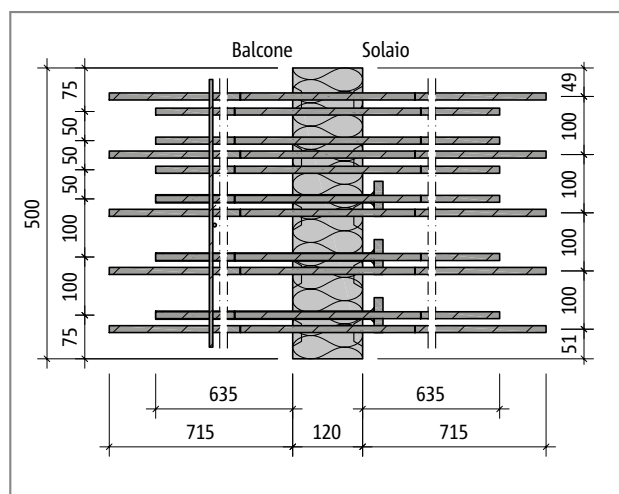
Schöck Isokorb® tipo EXT50-L-V12: pianta del prodotto
